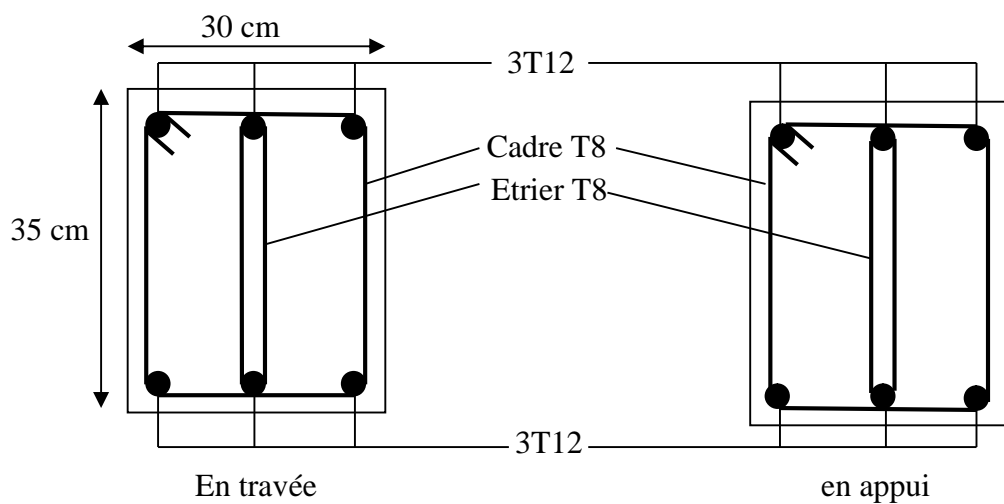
Schéma de ferrailage de la poutre secondaire des étages
